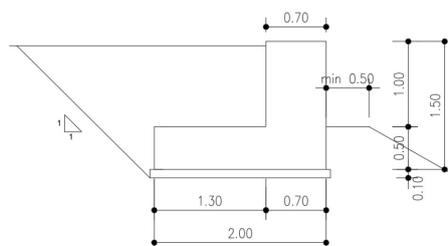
Sezione trasversale tipologica del cordolo di contenimento del rilevato
